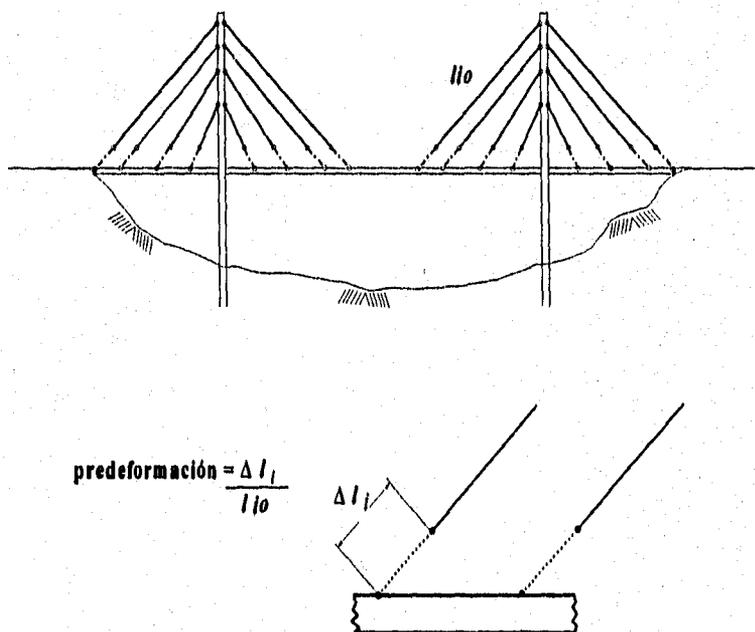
Definición estructural de la longitud neutra de cada tirante (l_0), para la fabricación geométrica de un puente (suponiendo el pilón vertical y el tablero recto por simplificación), donde la pre-deformación está dada claramente desde el intervalo entre el extremo del cable y el tablero.
